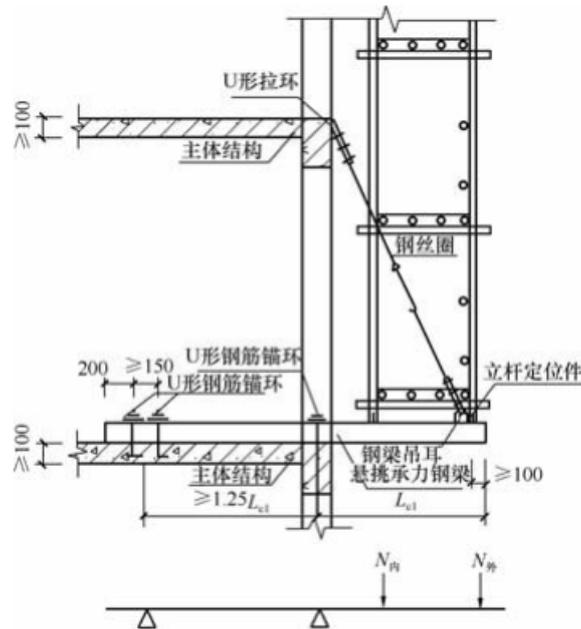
钢丝绳辅助吊拉挑梁式承力架构造及计算简图
